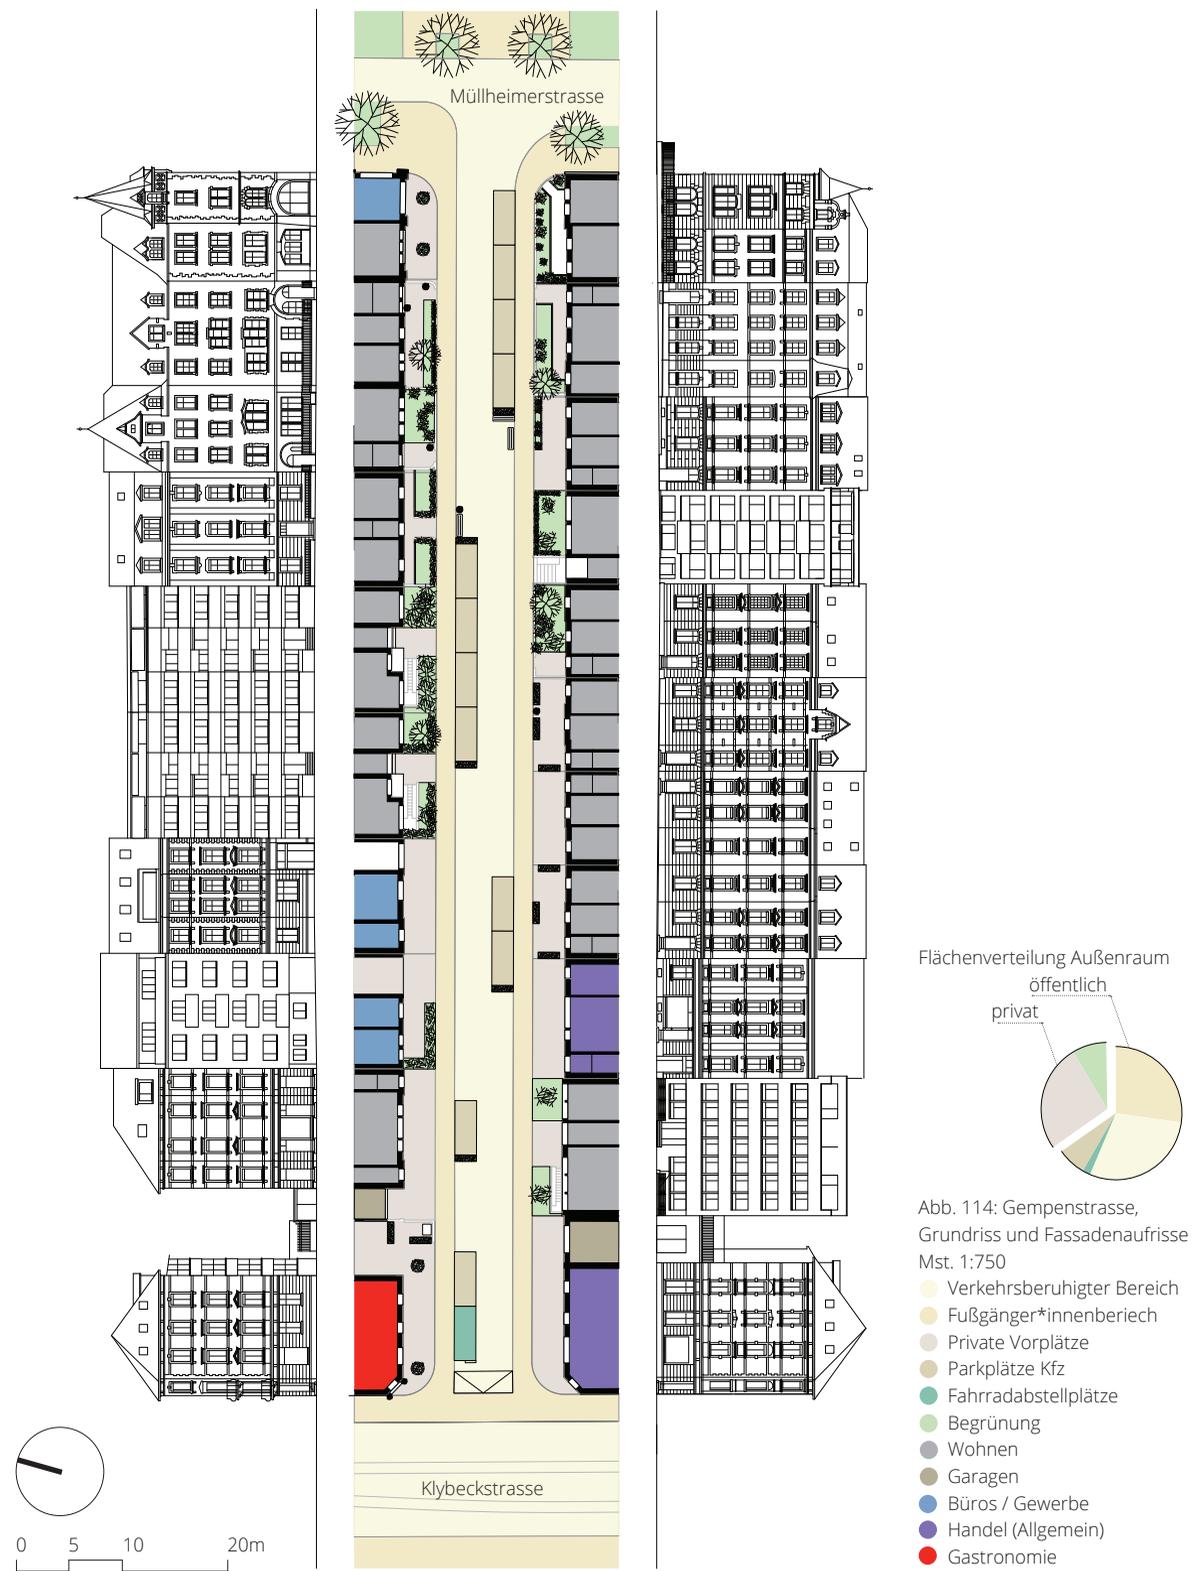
Gempenstrasse, Grundriss und Fassadenaufrisse Mst. 1:750
